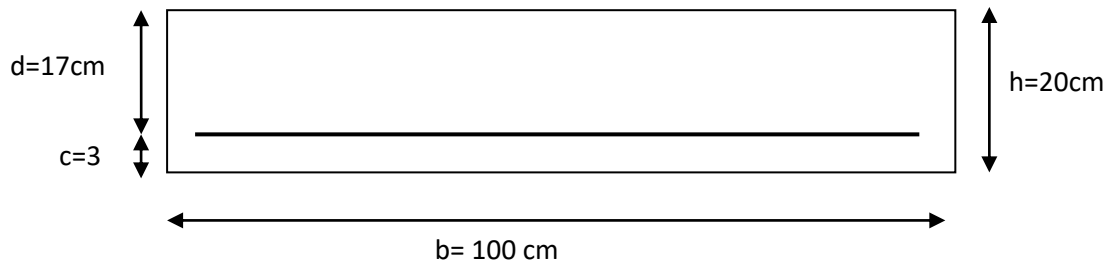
Schéma statique du ferrailage de mur plaque
